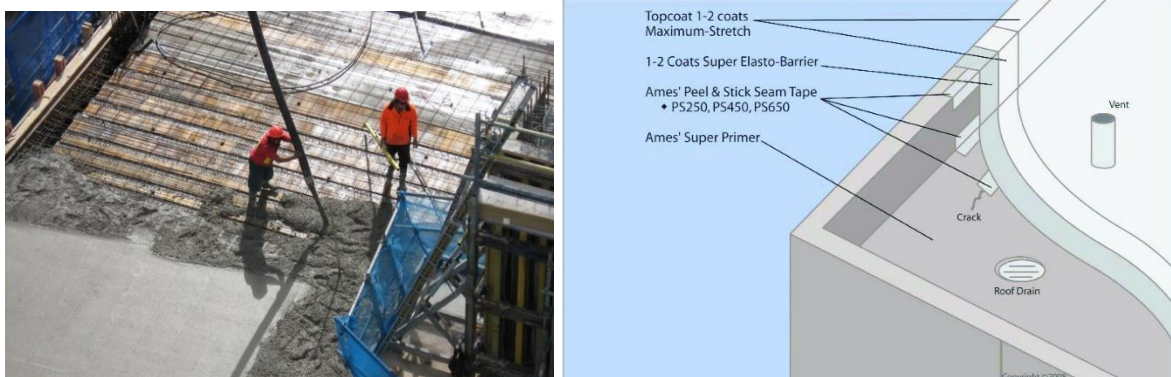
In-Situ Concrete for Floor Slabs
